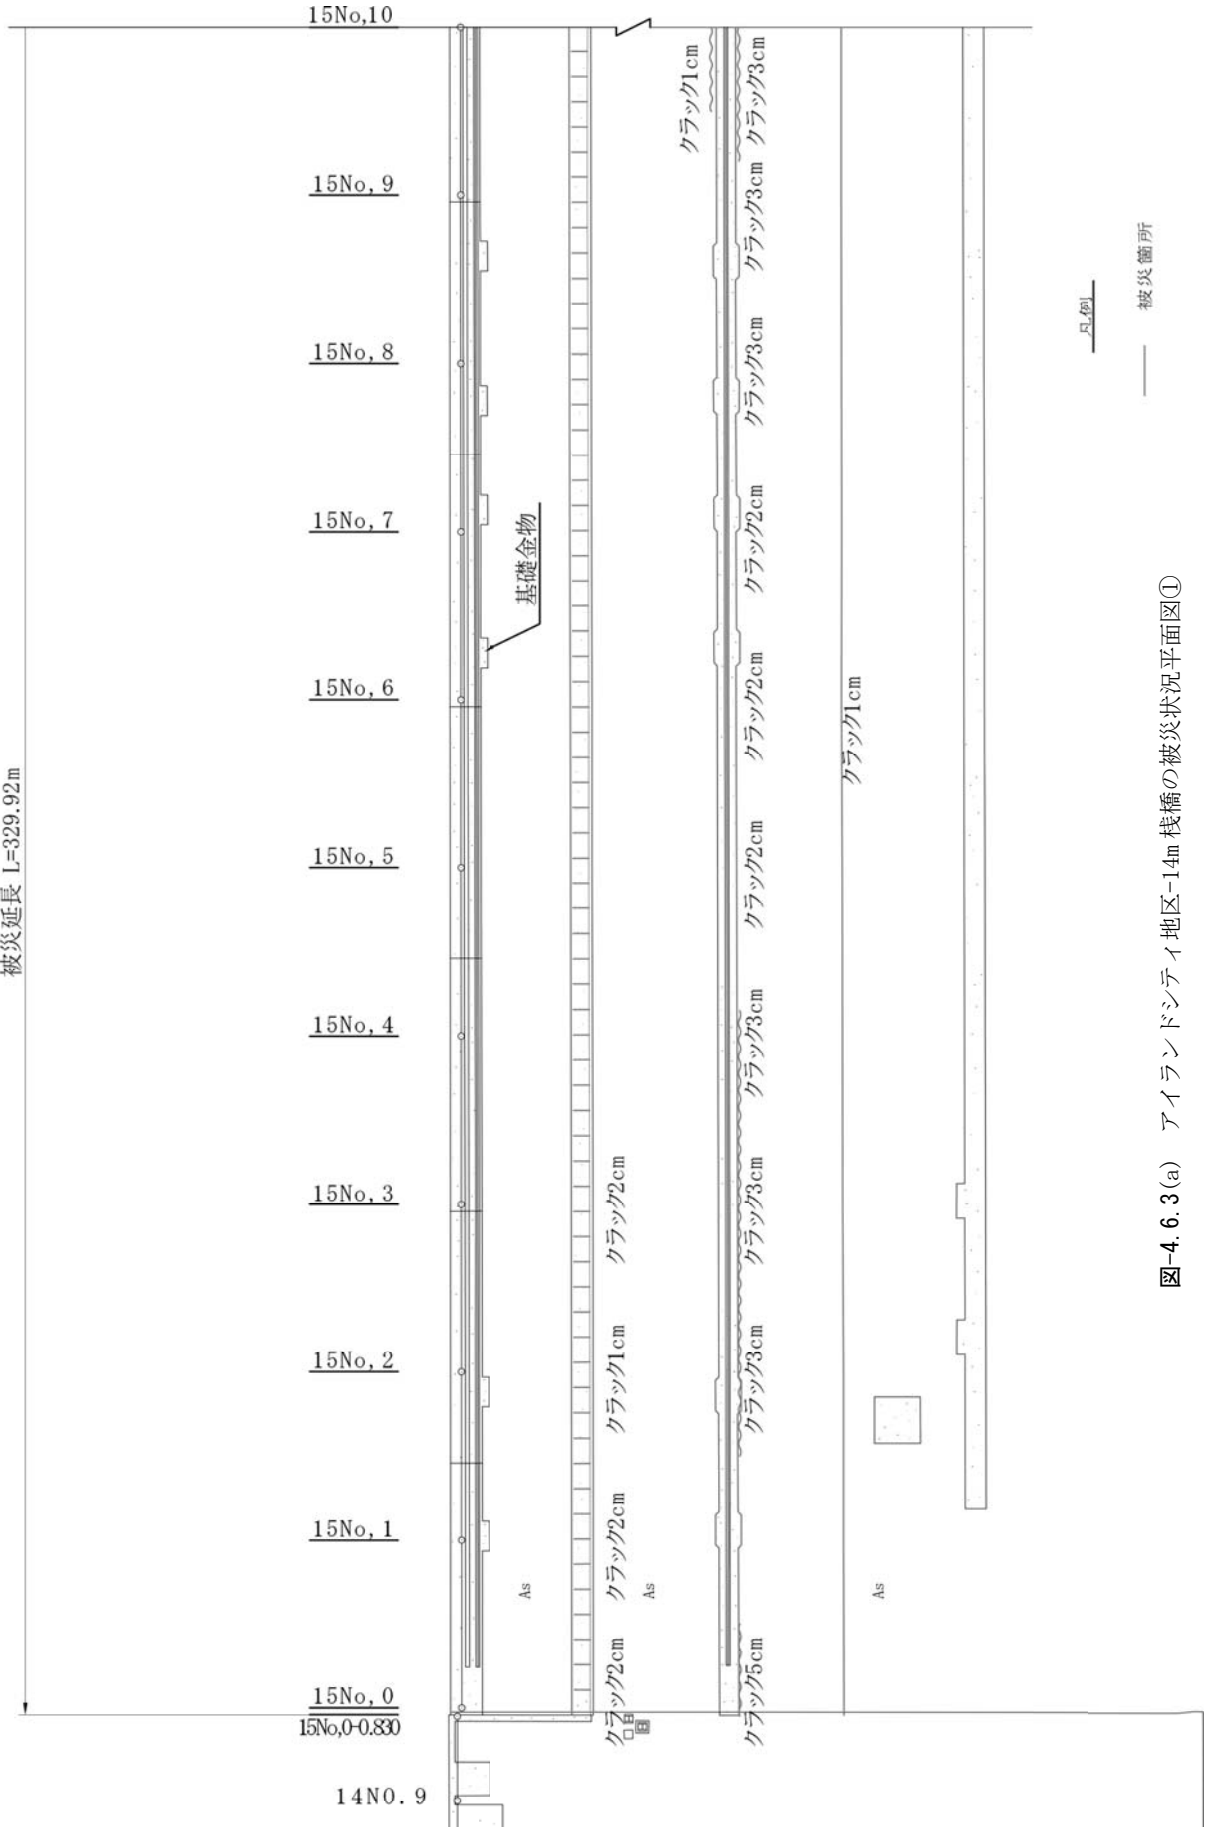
(a) アイランドシテイ地区-14m 栈橋の被災状況平面図①
